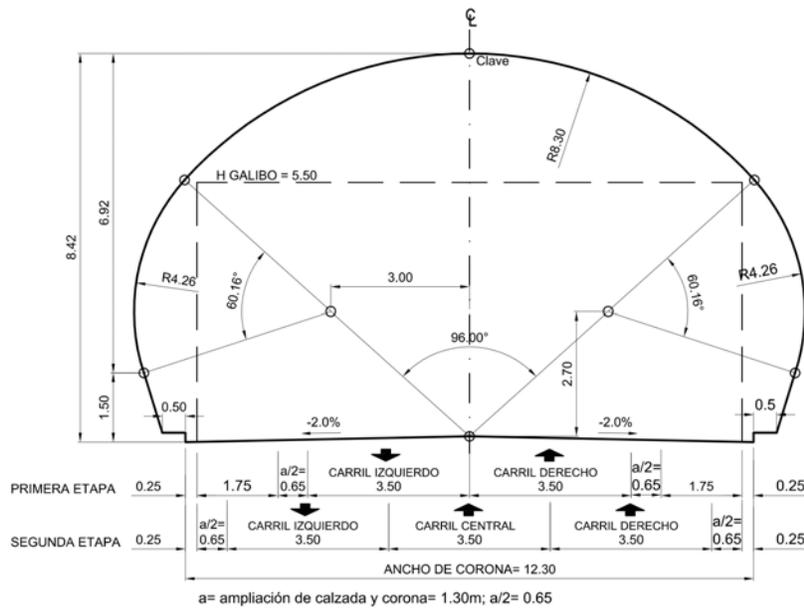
Sección tipo en tangente para túnel de sentido bidireccional en carreteras Tipo A2 con longitud menor a 500 m. Línea de intradós.
